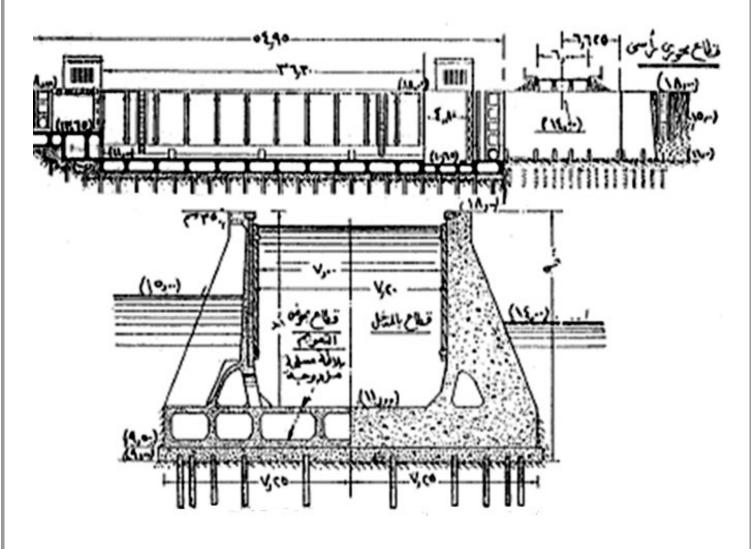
هويس كافانيلو داديج، إيطاليا، الحوائط فقط خرسانة مسلحة
